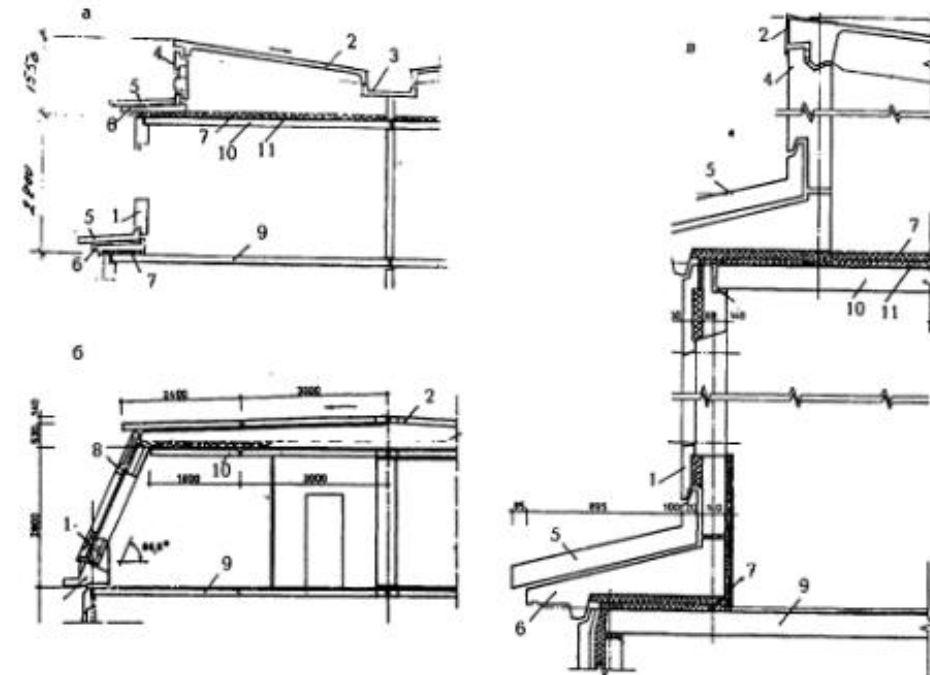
Схемы и детали конструкций мансард и надстроек из железобетонных панелей: а – с внутренним водостоком, вертикальной наружной стеной надстройки, размещенной из условий инсоляции с отступом из плоскости фасада; б – с наружным водостоком; в – детали мансарды типа "а"; 1 – утепленная панель наружной стены мансарды; 2 – кровельная панель; 3 – лоток; 4 – фризная панель чердака; 5 – облицовочная плита; 6 – карнизная плита; 7 – утеплитель; 8 – декоративная "холодная" панель; 9 – панель междуэтажного перекрытия; 10 – то же, чердачного; 11 – пароизоляция
